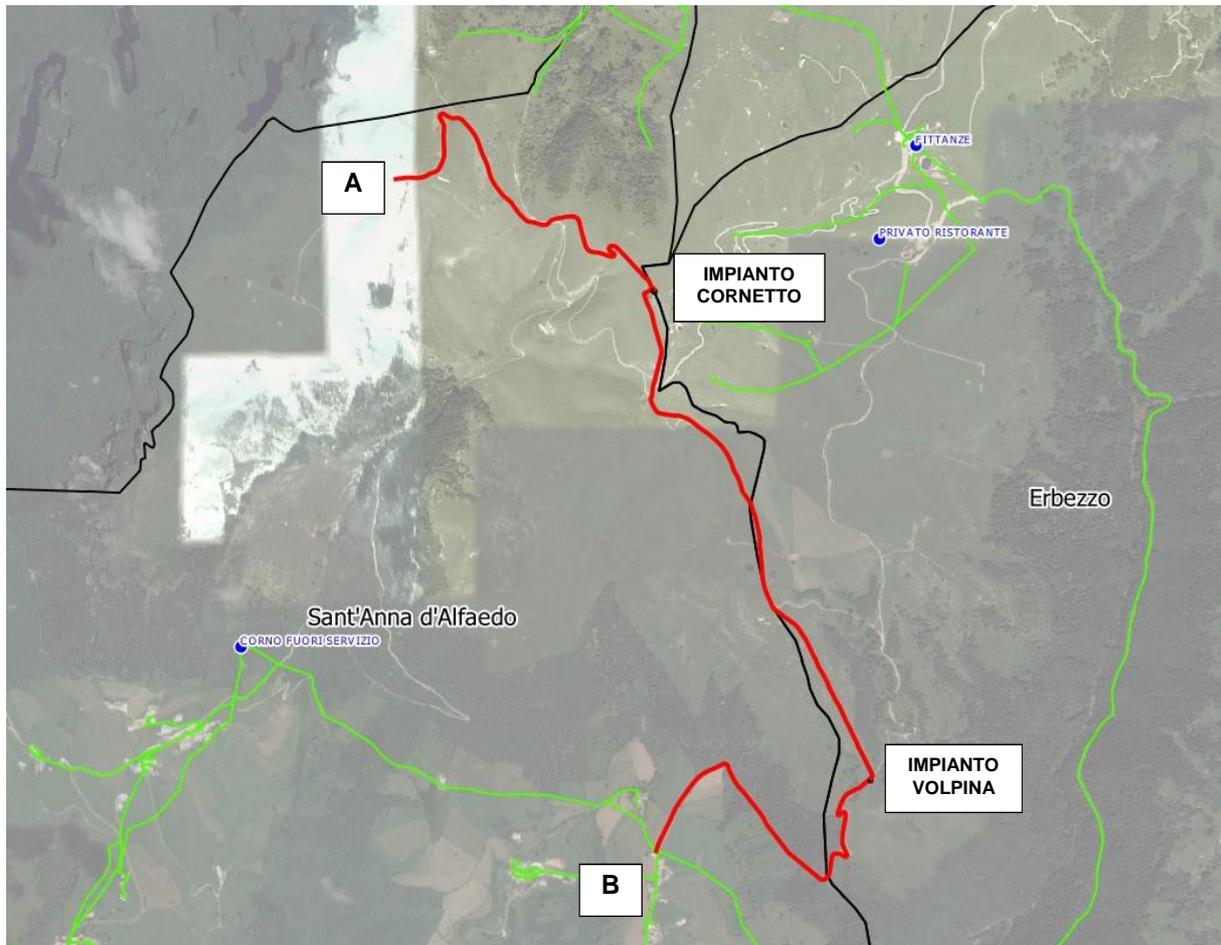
Planimetria generale del tracciato AB. In rosso il tracciato di progetto, in verde la rete esistente.
